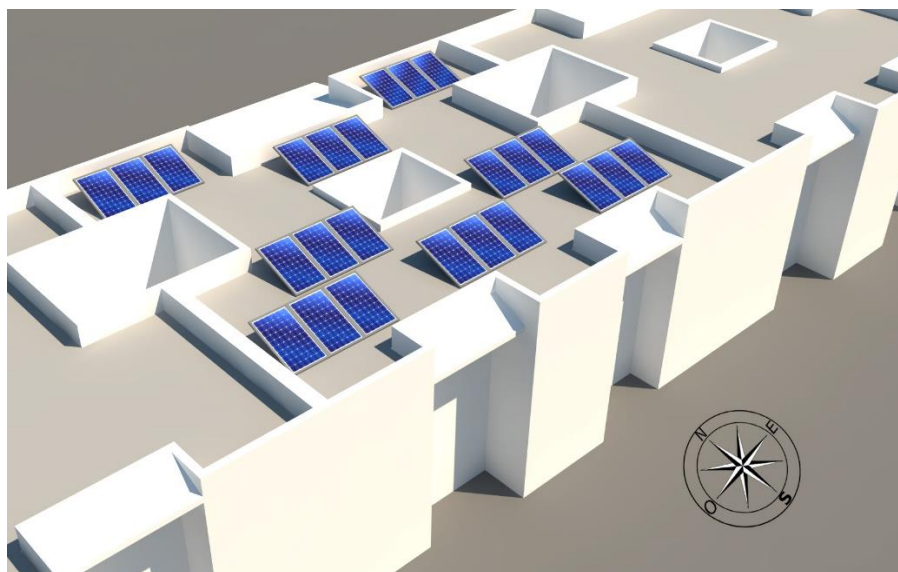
Planta Arquitectónica Azotea con la distribución de los paneles. Fuente: Elaboración propia.
